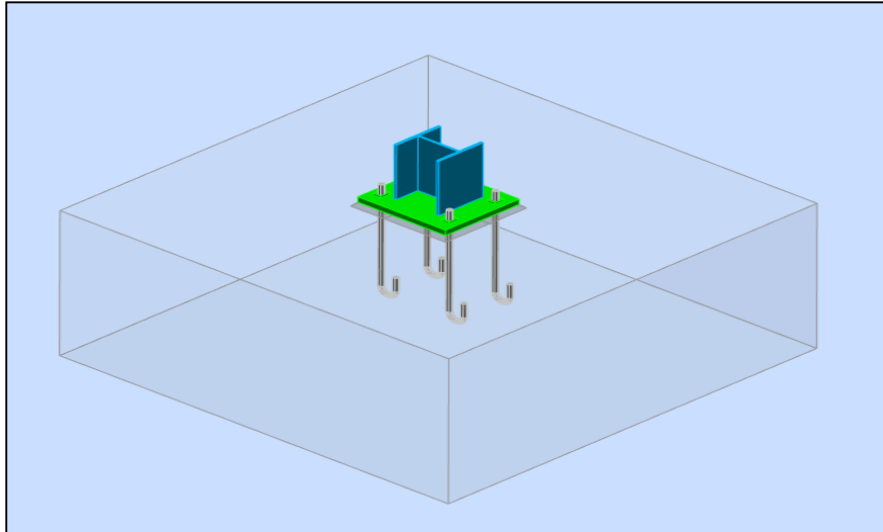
Vue 3D de la jonction poteau-fondation fondation.
